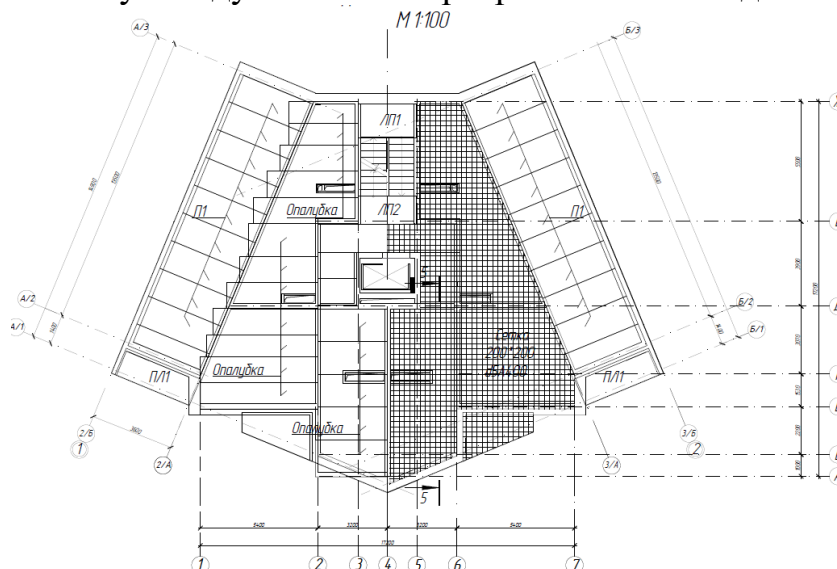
Схема плана монолитного перекрытия (центральная секция)
